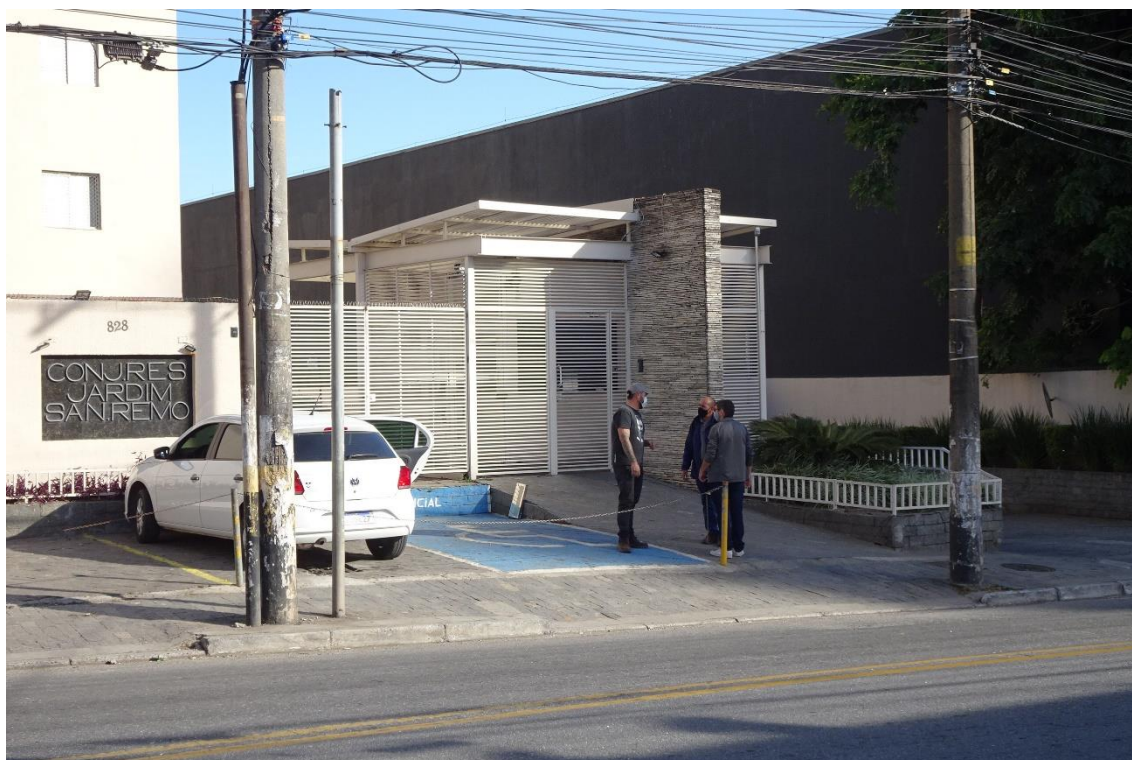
Vista da fachada do Edifício Ângela, Bloco A.
